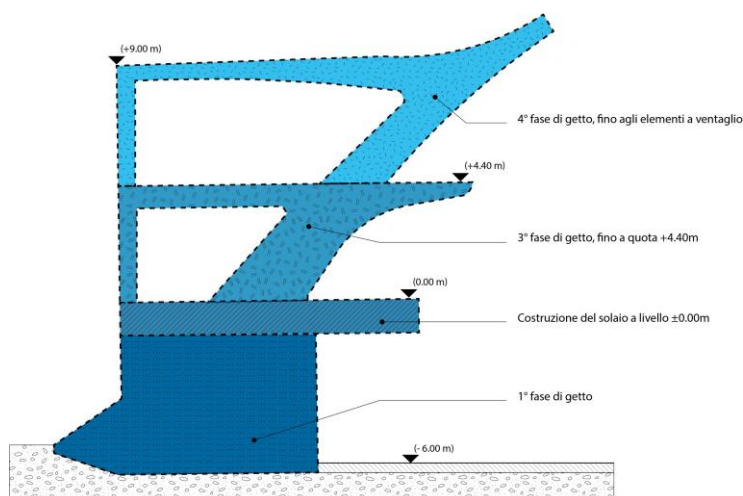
schematizzazione fasi di getto dei pilastri inclinati.
